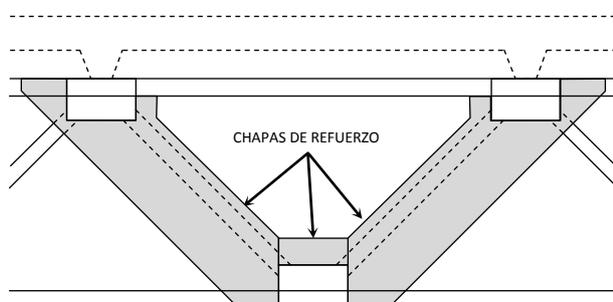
Detalle de Refuerzo de Diagonales de Apoyos.
